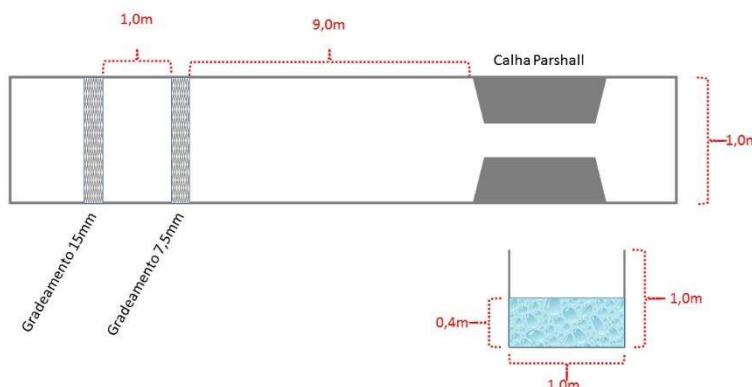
Croqui da Canaleta de Recebimento de Efluentes
